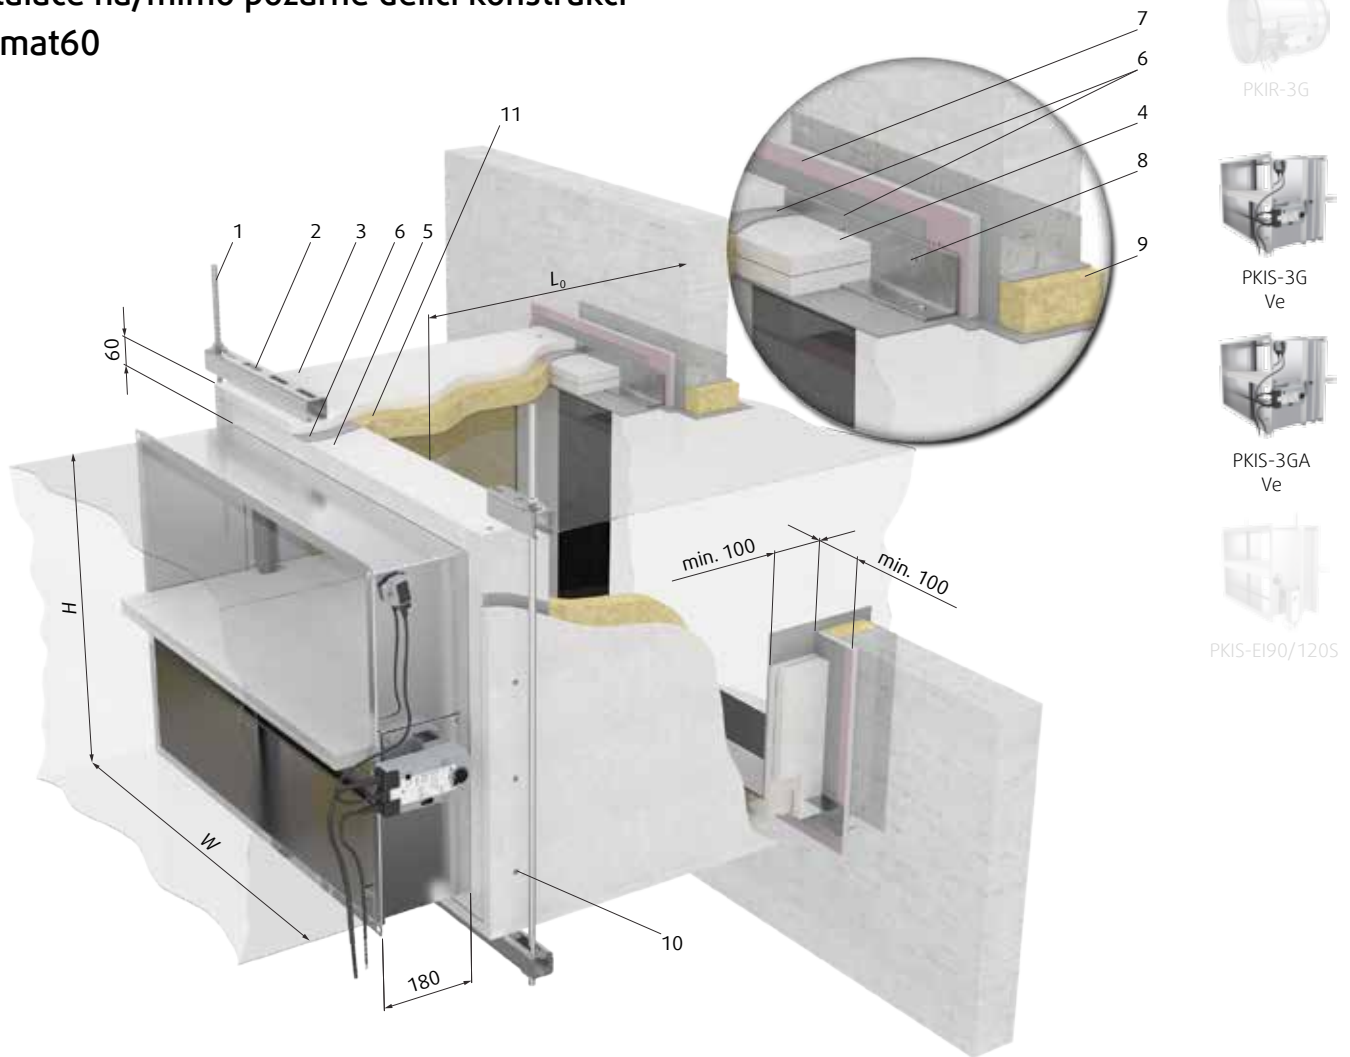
Instalace mimo/na požárně dělicí konstrukci v blízkosti stropu
